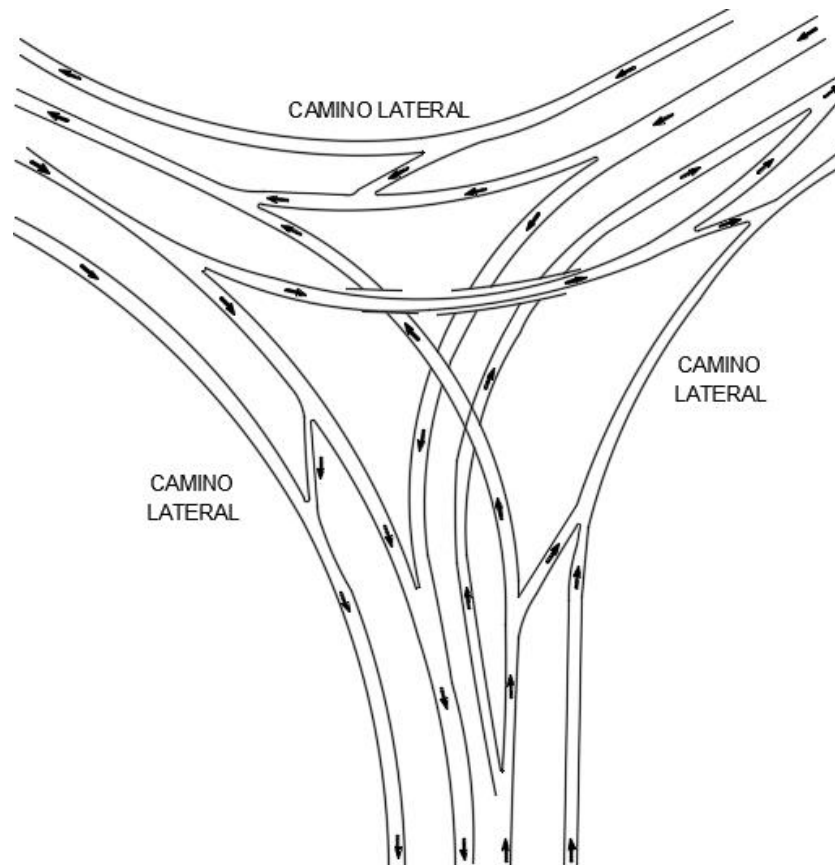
Proyecto semidireccional de un intersección de tres ramas
